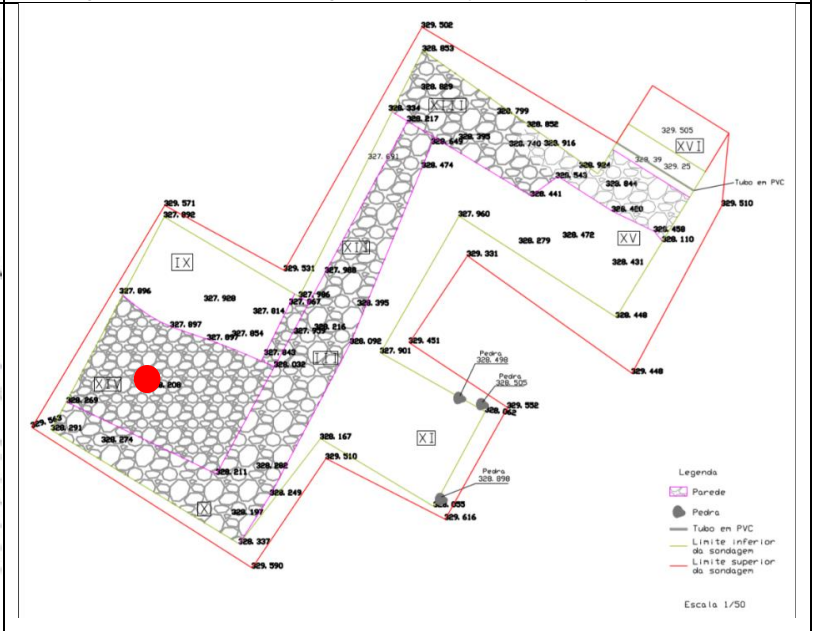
Planta das Sondagens. Localização da extração da amostra 2.
